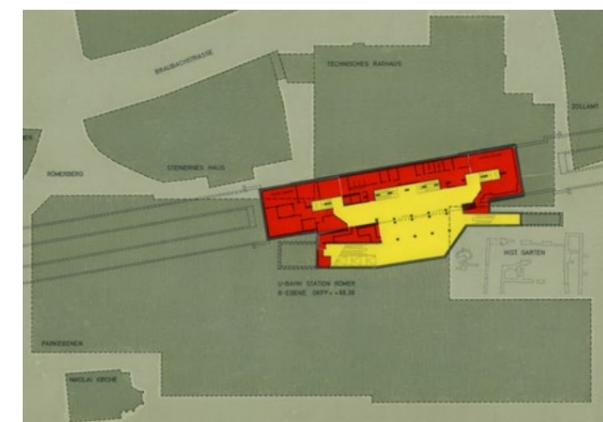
Frankfurt am Main, U-Bahnhof Römer; Grundriss, B-Ebene, vor 1974
